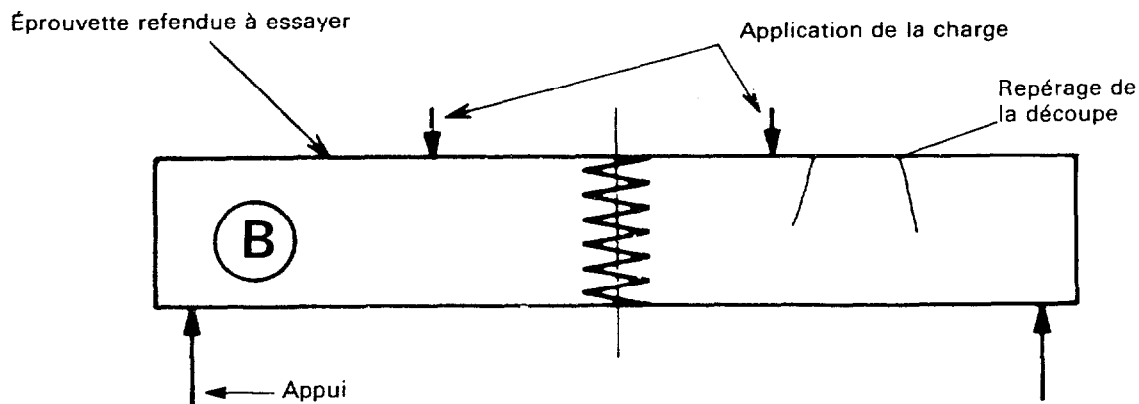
Position de l'éprouvette dans la machine d'essai dans le cas d'un élément refendu.
